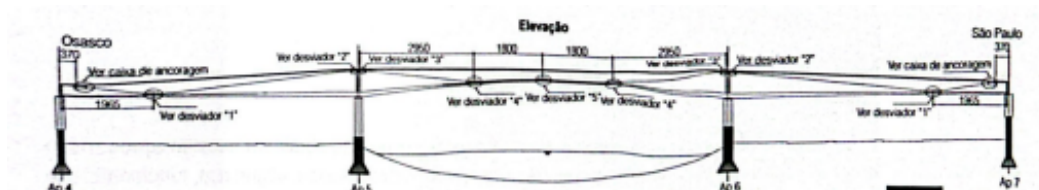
Esquema longitudinal da protensão de Reforço na Ponte dos Remédios com indicação do cabos de protensão e as caixas de ancoragem.
